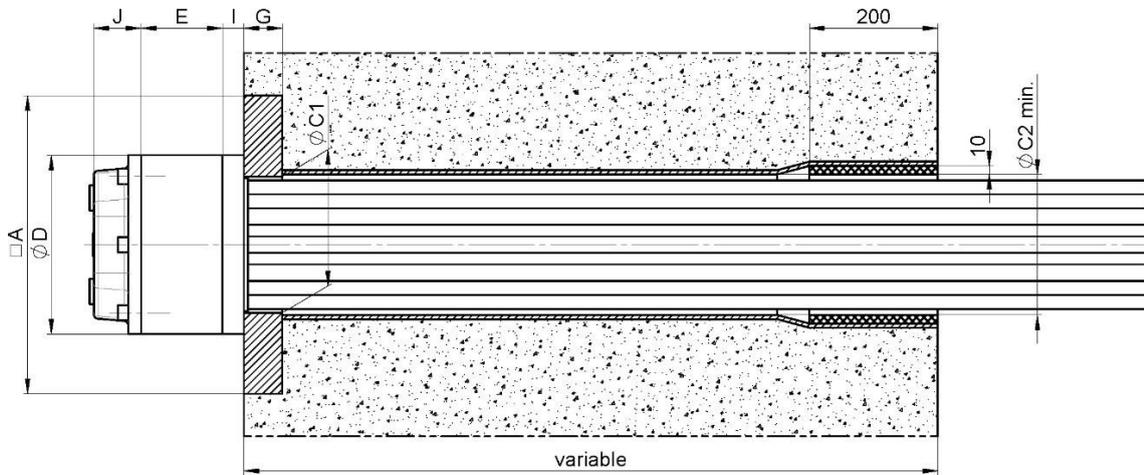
Ancrage type E-WT - Disposition sans plaque de calage - Dimensions
